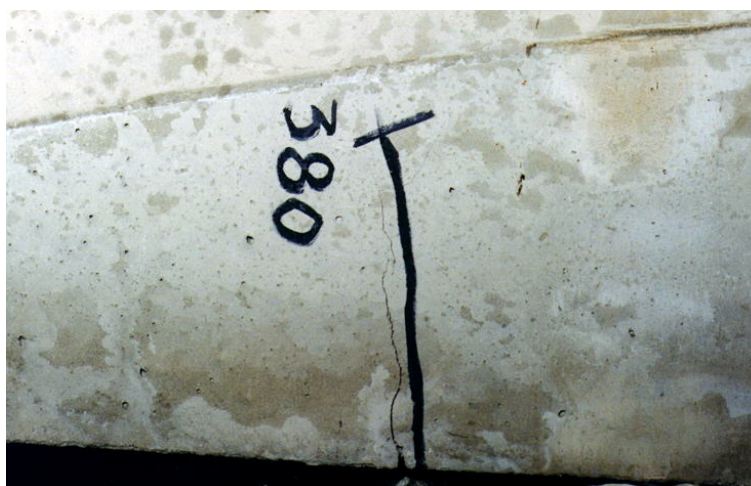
Configuração da fissuração numa das faces verticais do dormente sem fibras D14, após 360.000 ciclos de carga e sob a atuação da força estática de 380 kN.
